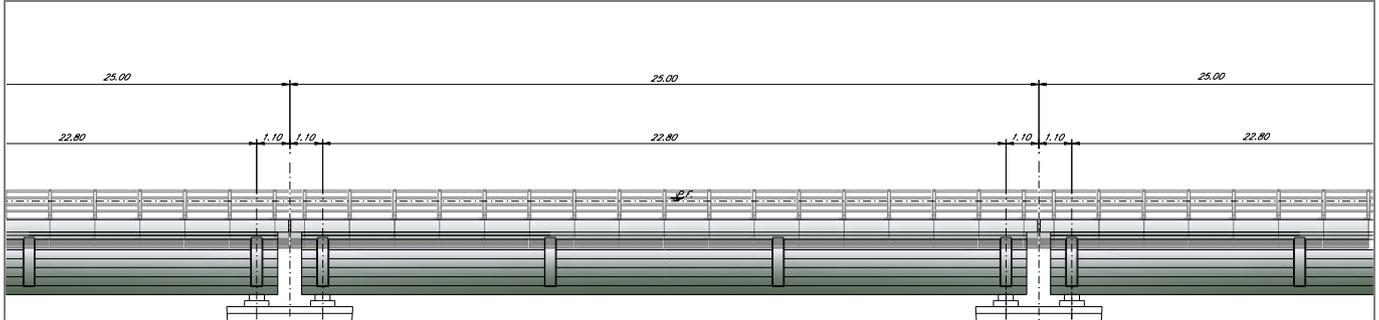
Prospetto tipo viadotto c.a.p. L=25.00m
